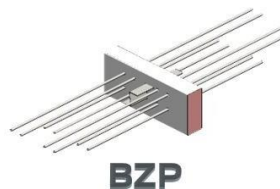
Vue 3D des modèles de traitement des linéaires dalle à prédalle – balcon – Procédé Slabe 8
